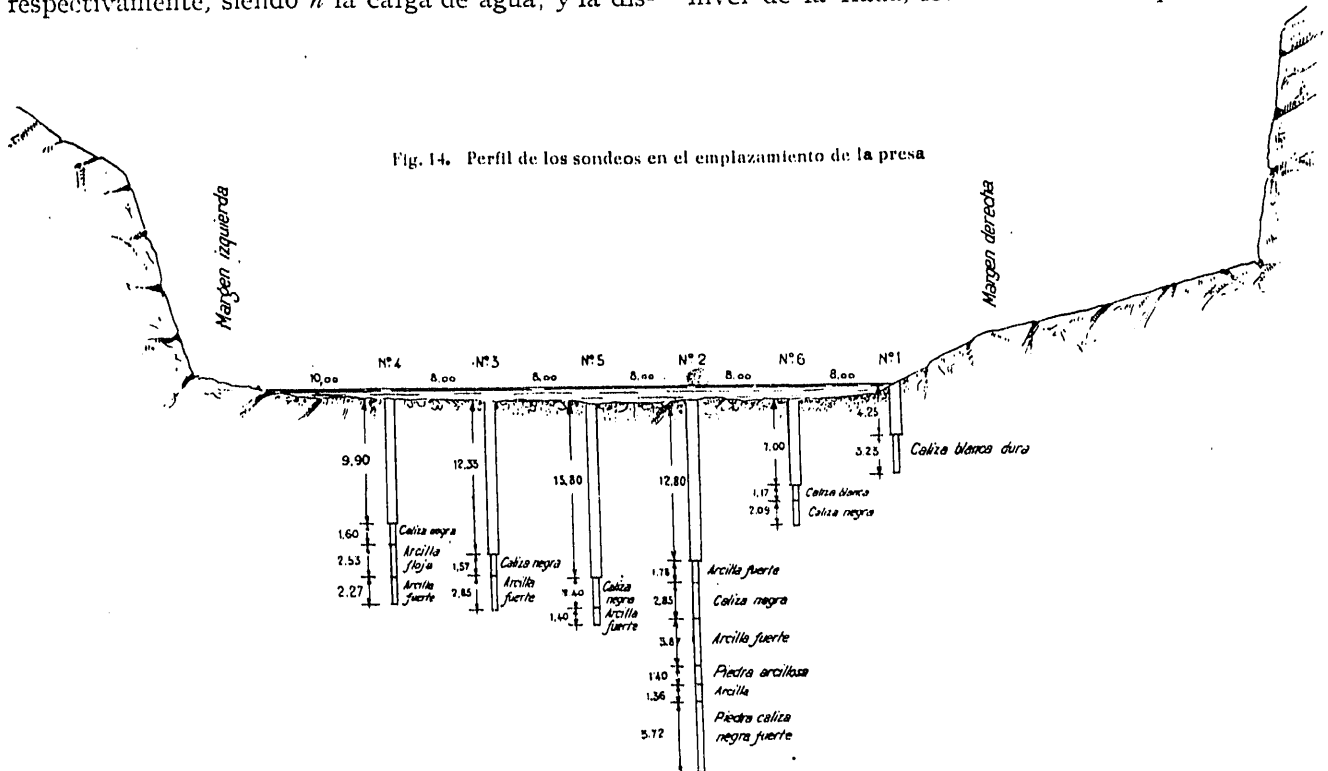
Perfil de los sondeos en el emplazamiento de la presa
